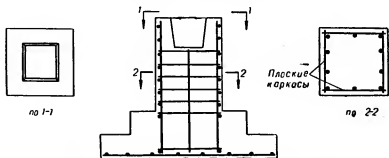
133. Железобетонный фундамент под сборные колонны с повышенной стаканной частью.
